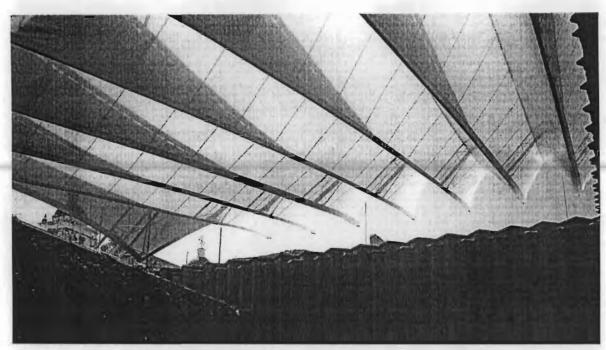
Cubierta terminada, restaurante Los Danzantes, Oaxaca
